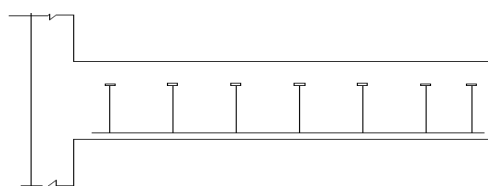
Configuração típica do sistema de armadura de cisalhamento do tipo Stud Rail em torno do pilar
